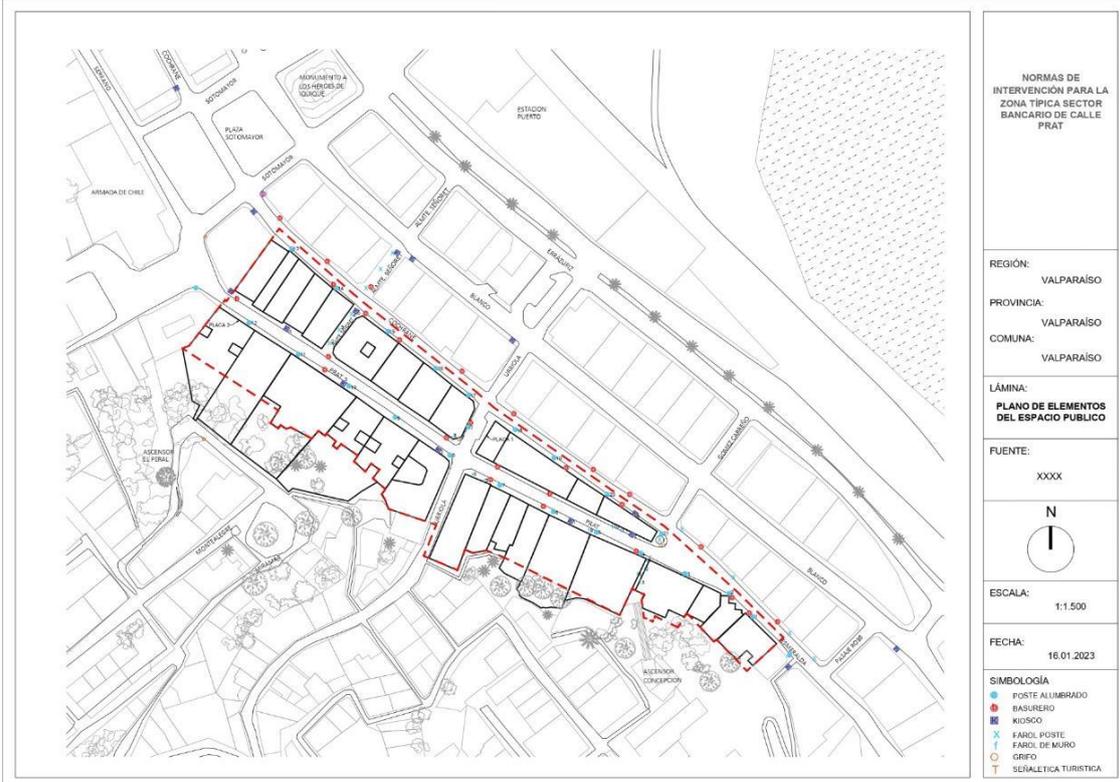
Plano de elementos del espacio público. Planimetría ampliada en anexo nº8. Fuente: elaboración propia.
